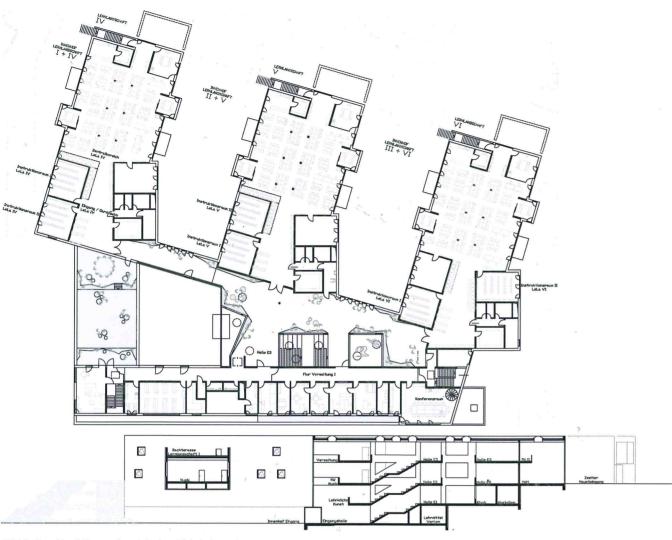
Grundriss 3. Obergeschoss (oben) und Schnitt (unten)
